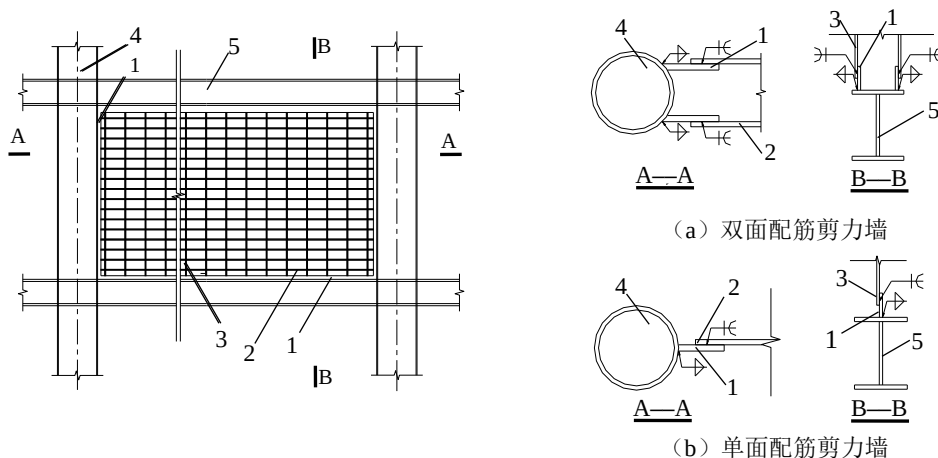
钢筋混凝土剪力墙和钢管再生混凝土边框柱连接构造
